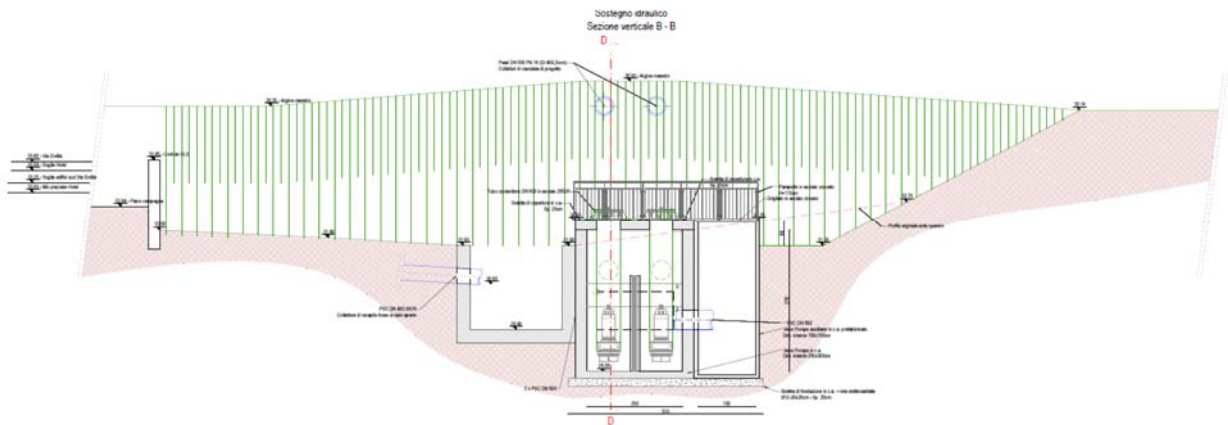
Sezione verticale trasversale impianto di sollevamento.
